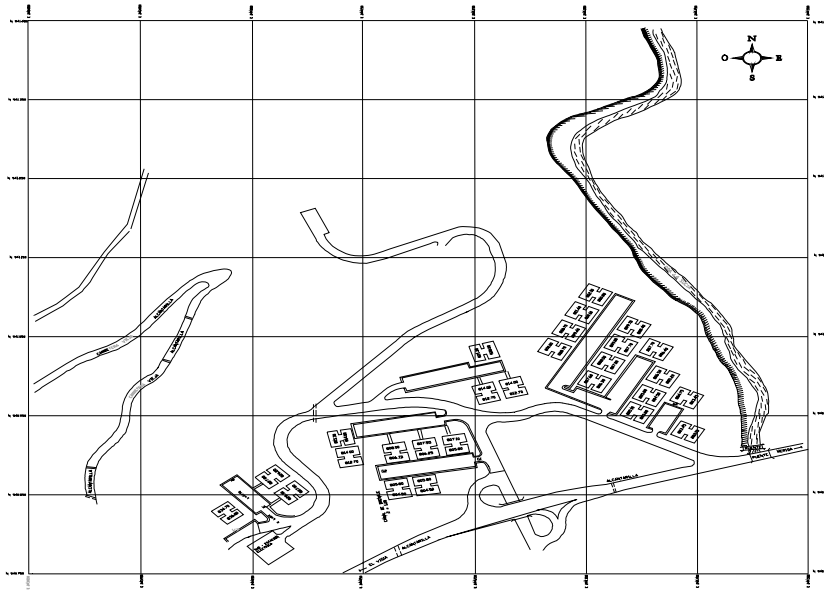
Plano de la sección norte de la urbanización Chama - Mérida
